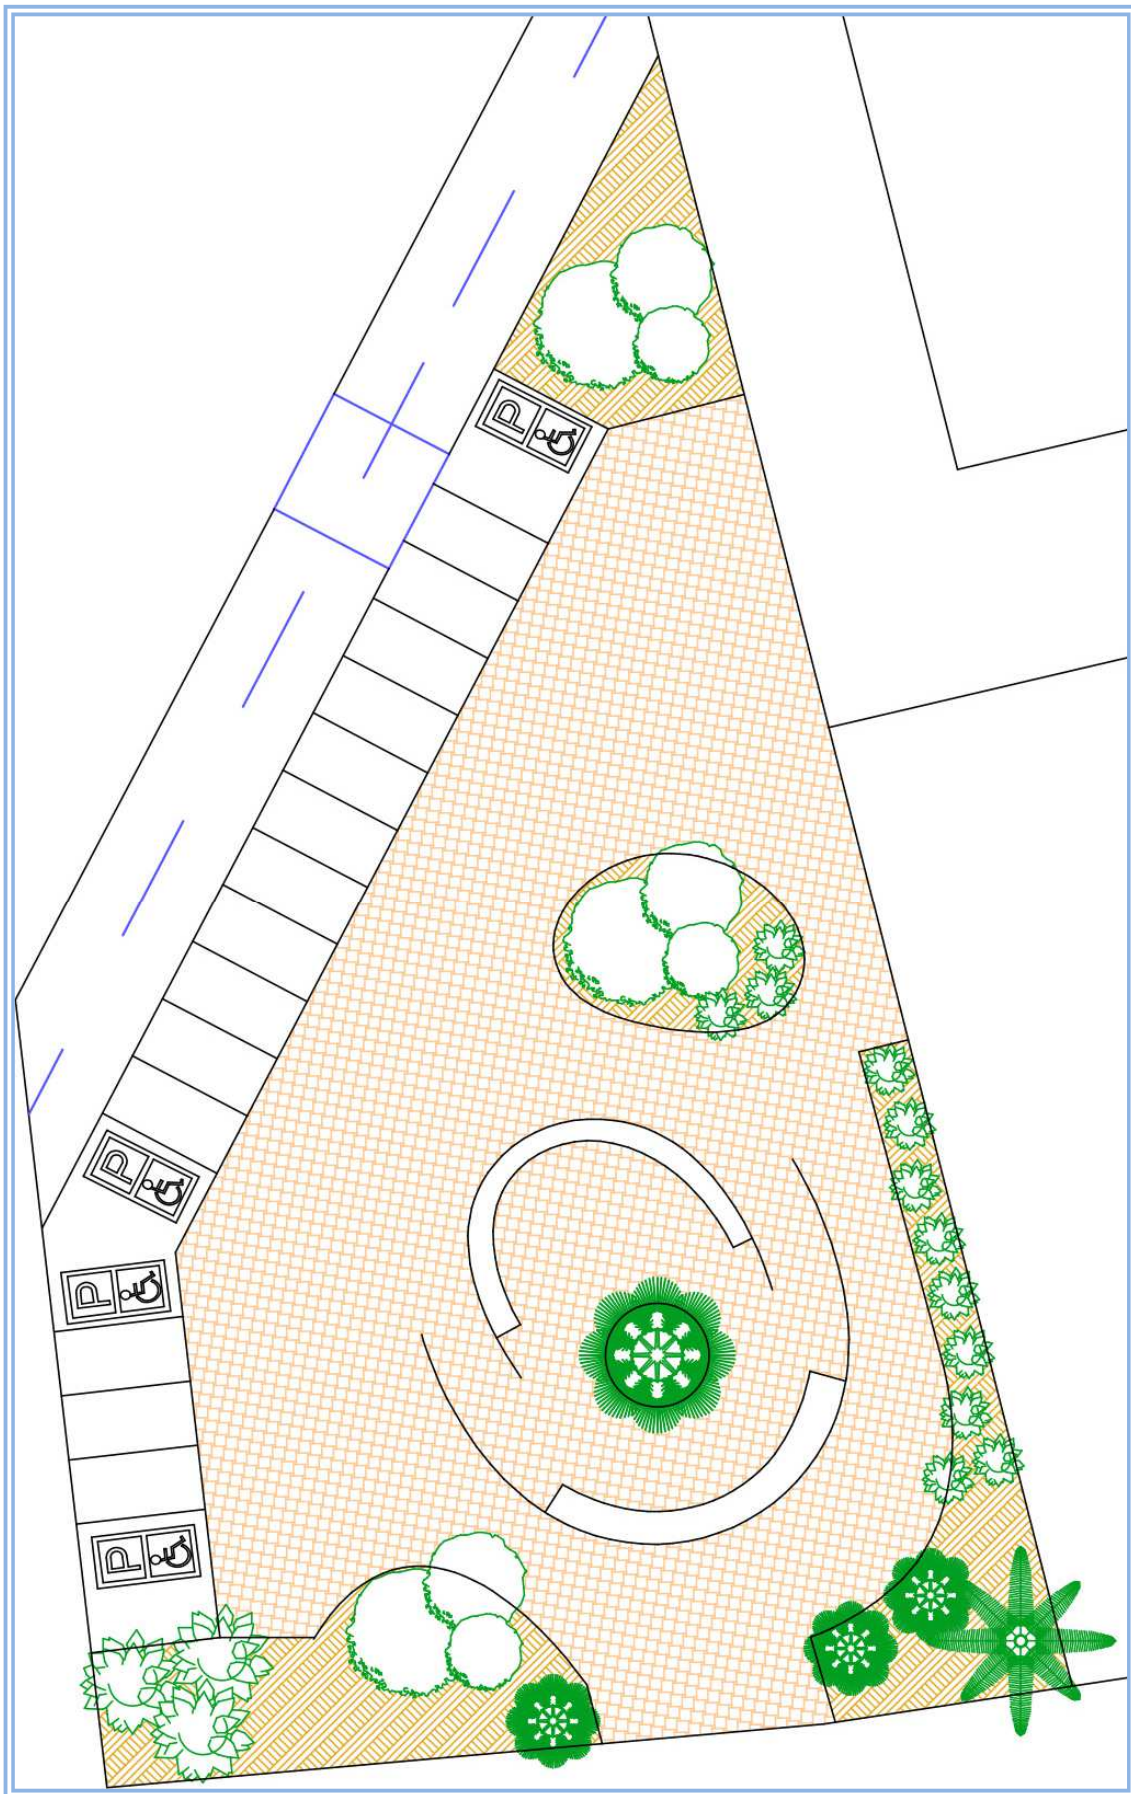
Planimetria area a verde attrezzato e parcheggi
